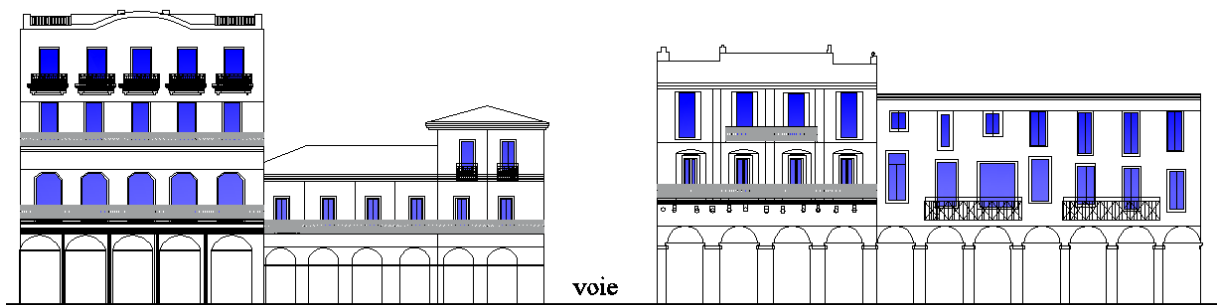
Façade Nord-ouest (place du 1er Novembre) dessiné sur Autodesk-Autocad.
